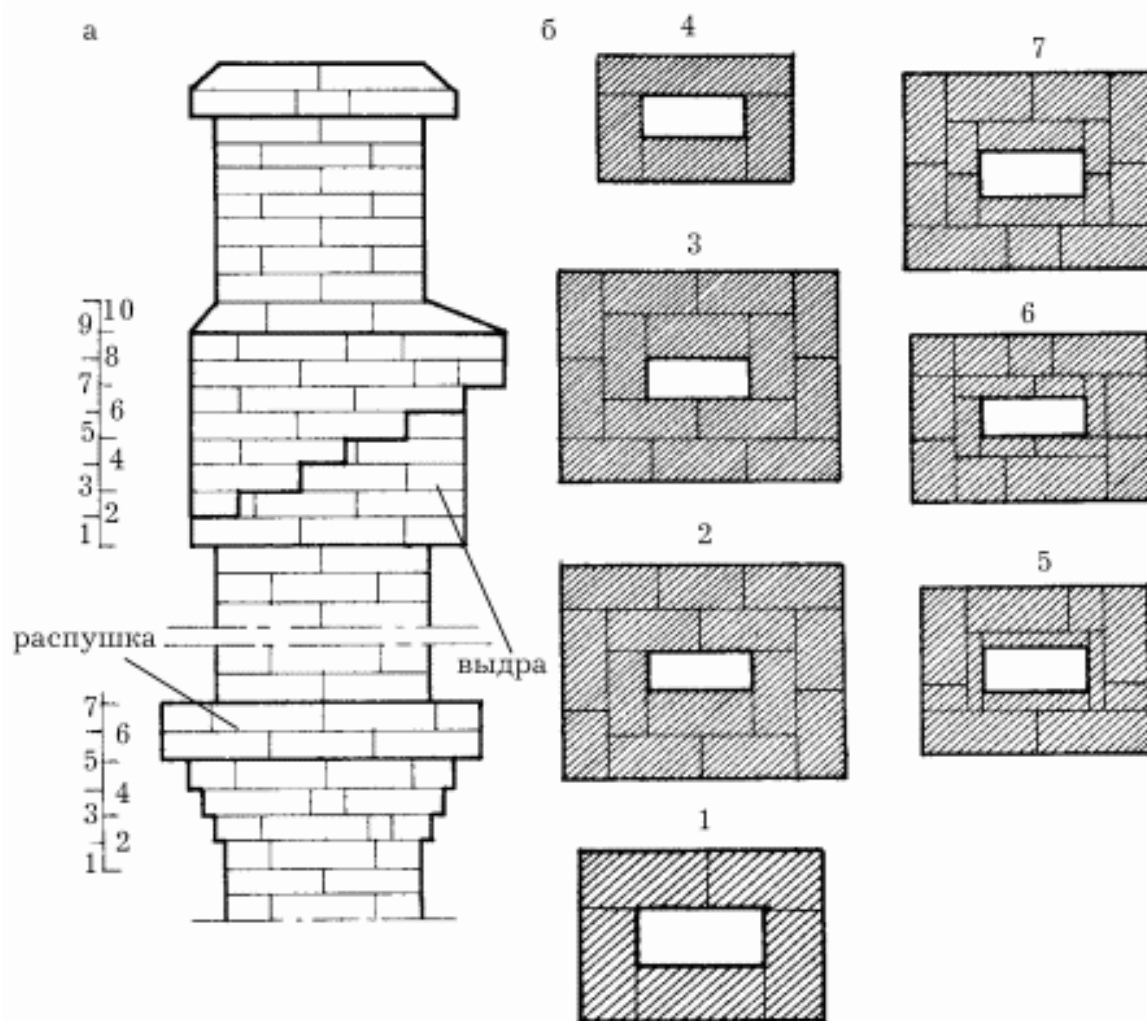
Труба: а – основные части; б – порядовки; 1–7 – шейка и распушка.
